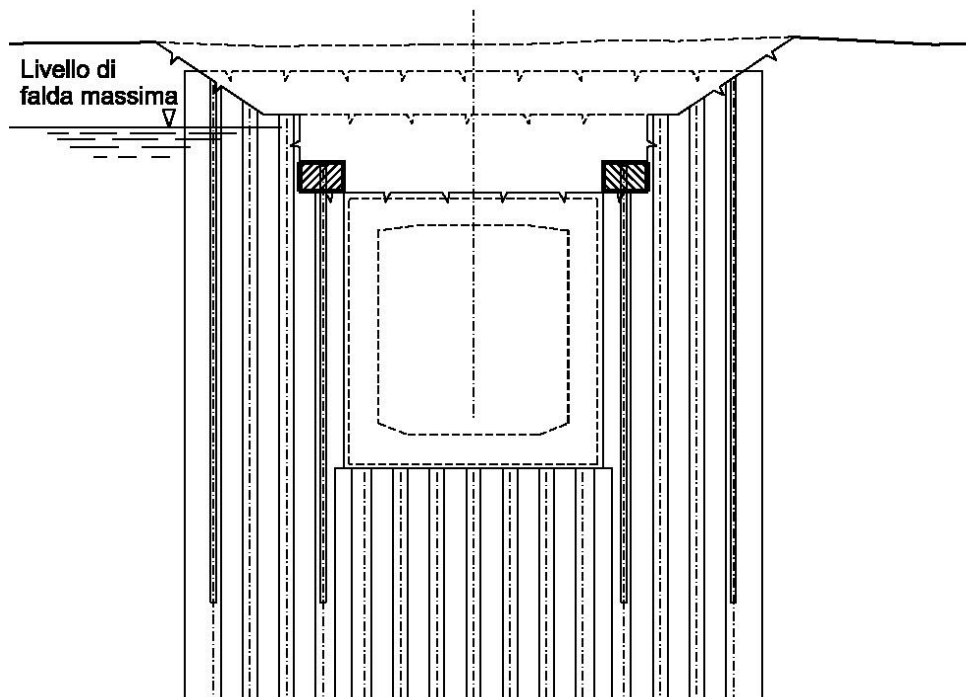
Aushub zum Bau des Aufteilungsträgers der Streben und Bau desselben.
